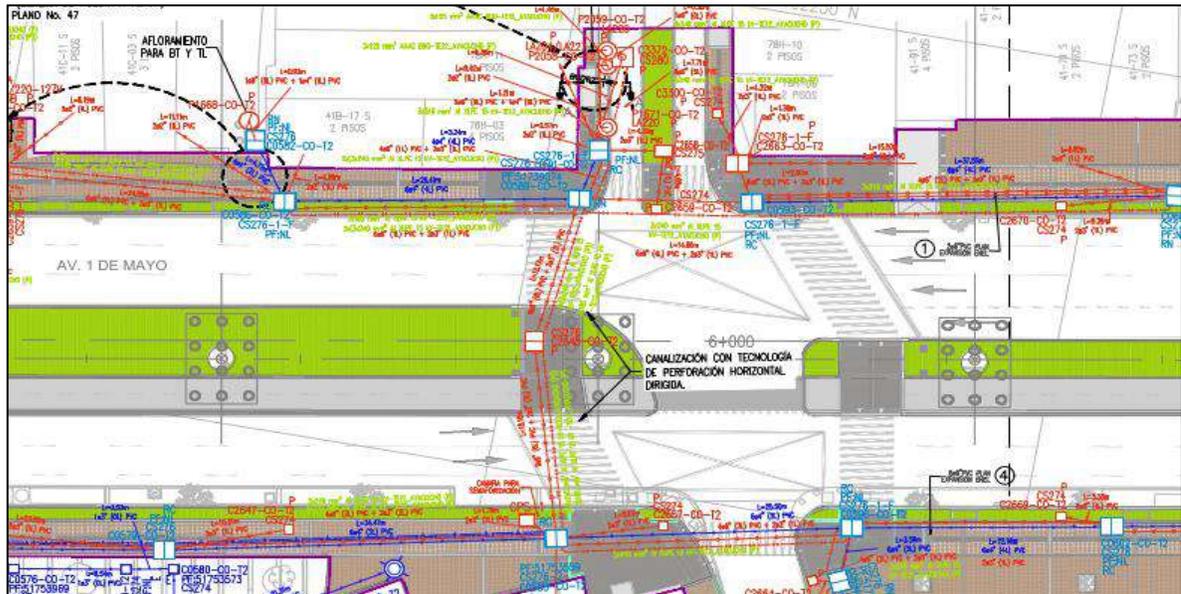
Plano de localización general de la red ENE2-14 pila S5-7
